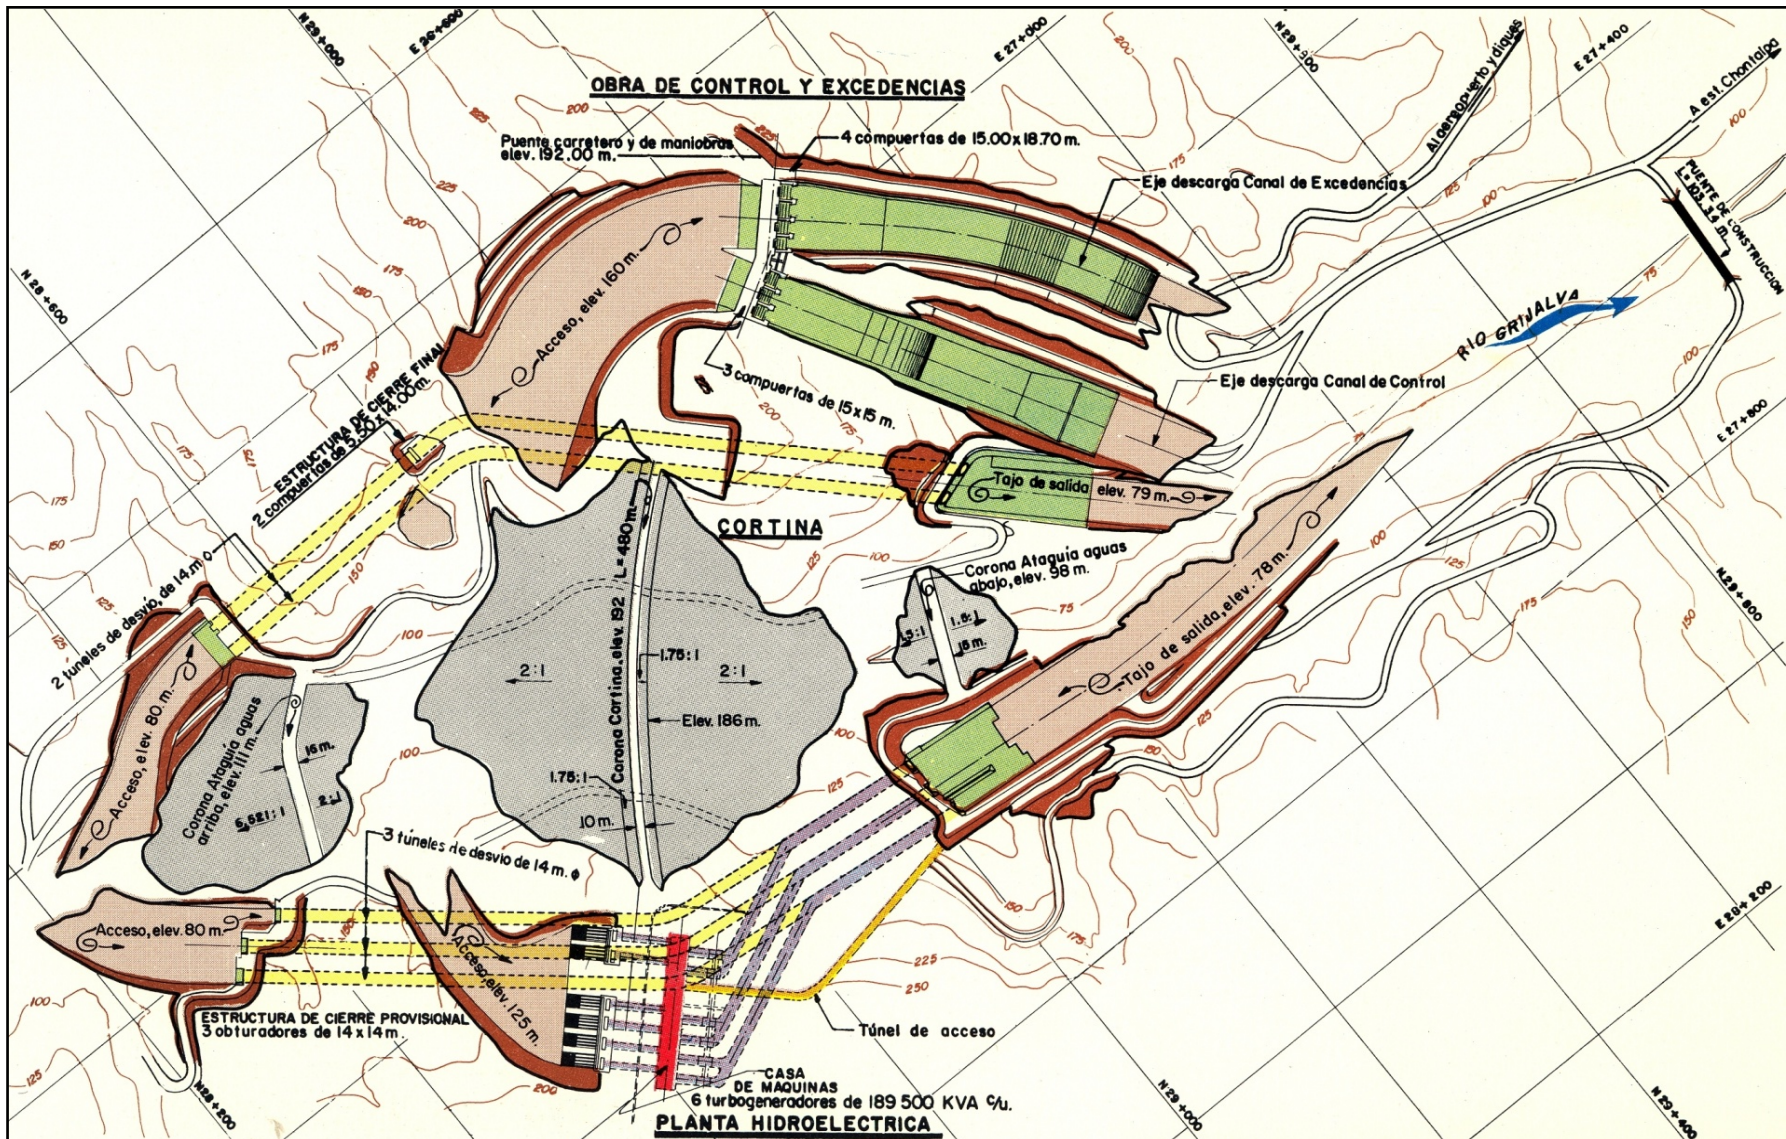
Planta General de la presa Netzahualcóyotl “Malpaso”.
